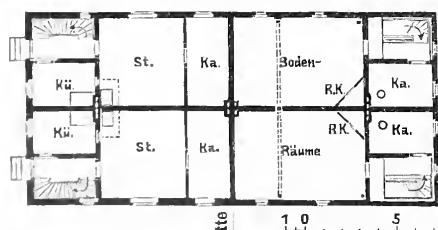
Wärterwohnhaus. Grundrisse.
